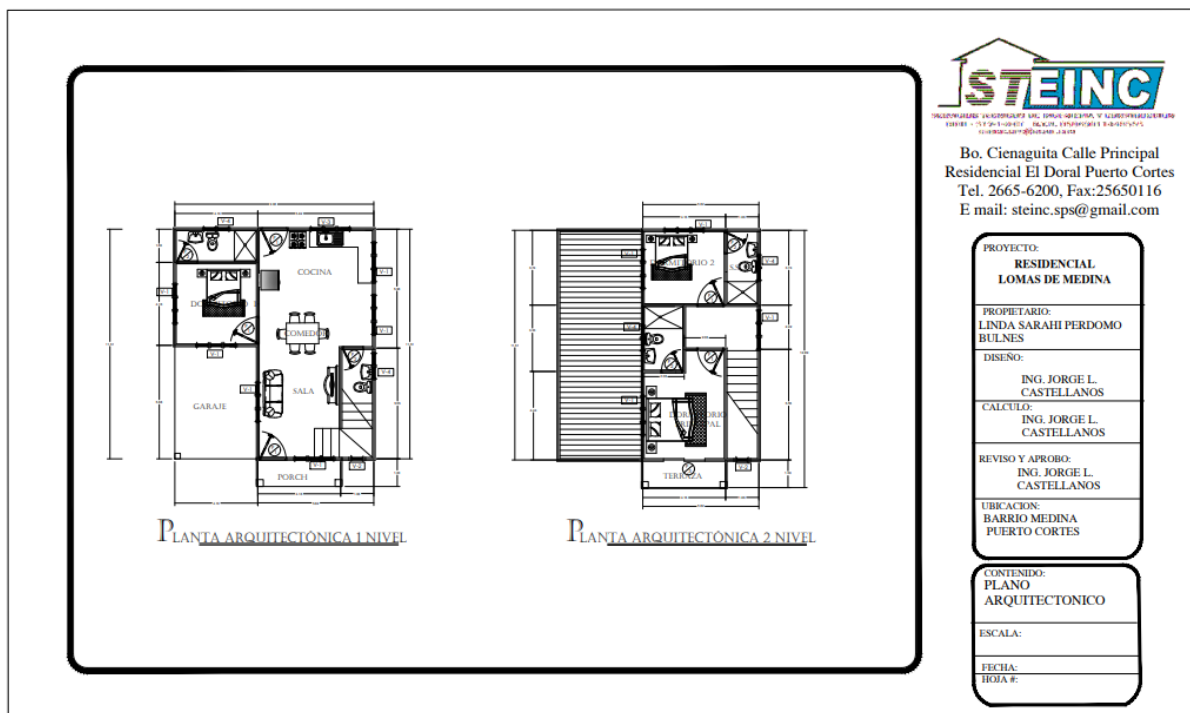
Plano Arquitectónico Casa 2 Niveles
